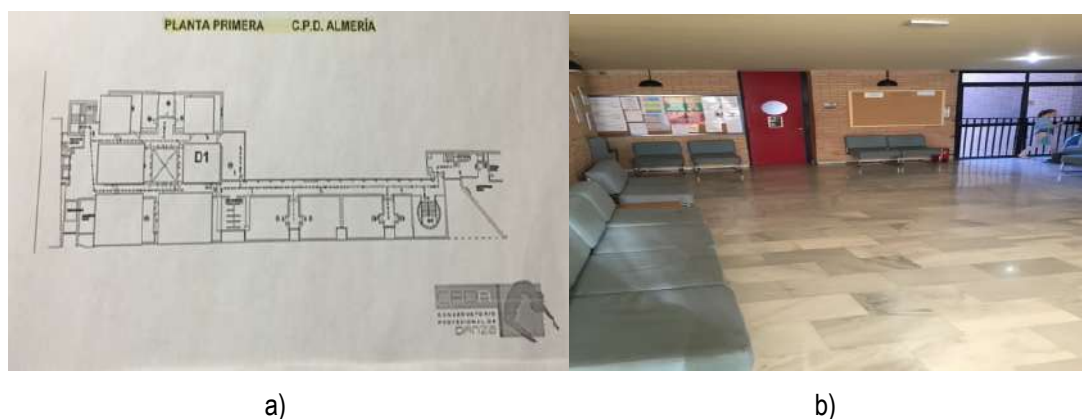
a) Distribución de planta 1.ª: CPD de Almería; b) Vestibulo de 3.ª planta.
